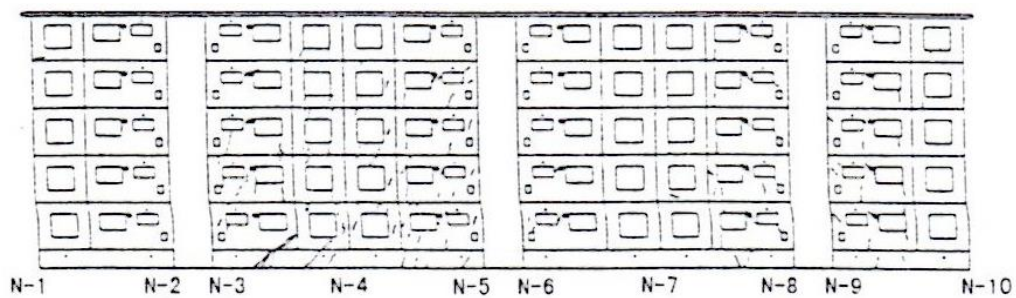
団地 F(WPC) ひび割れ発生状況
